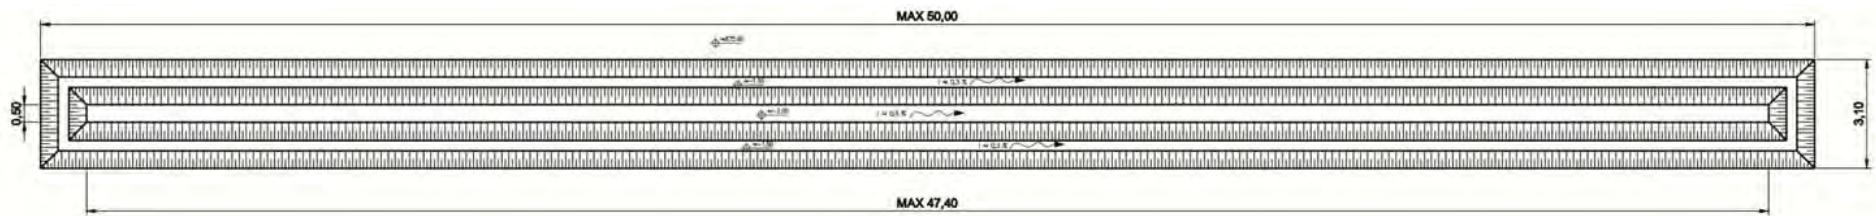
Stralcio del progetto della trincea esplorativa del bacino Monte Alto (pianta e sezione), febbraio 2010
